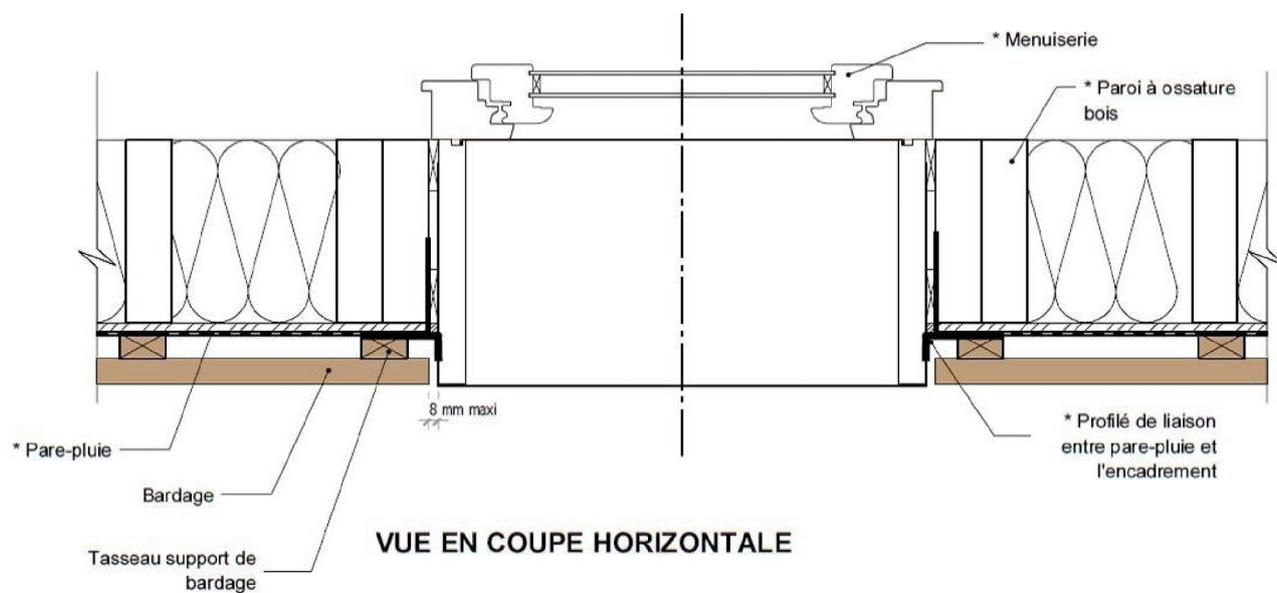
Protection du calfeutrement par un profilé de liaison – coupe horizontale
